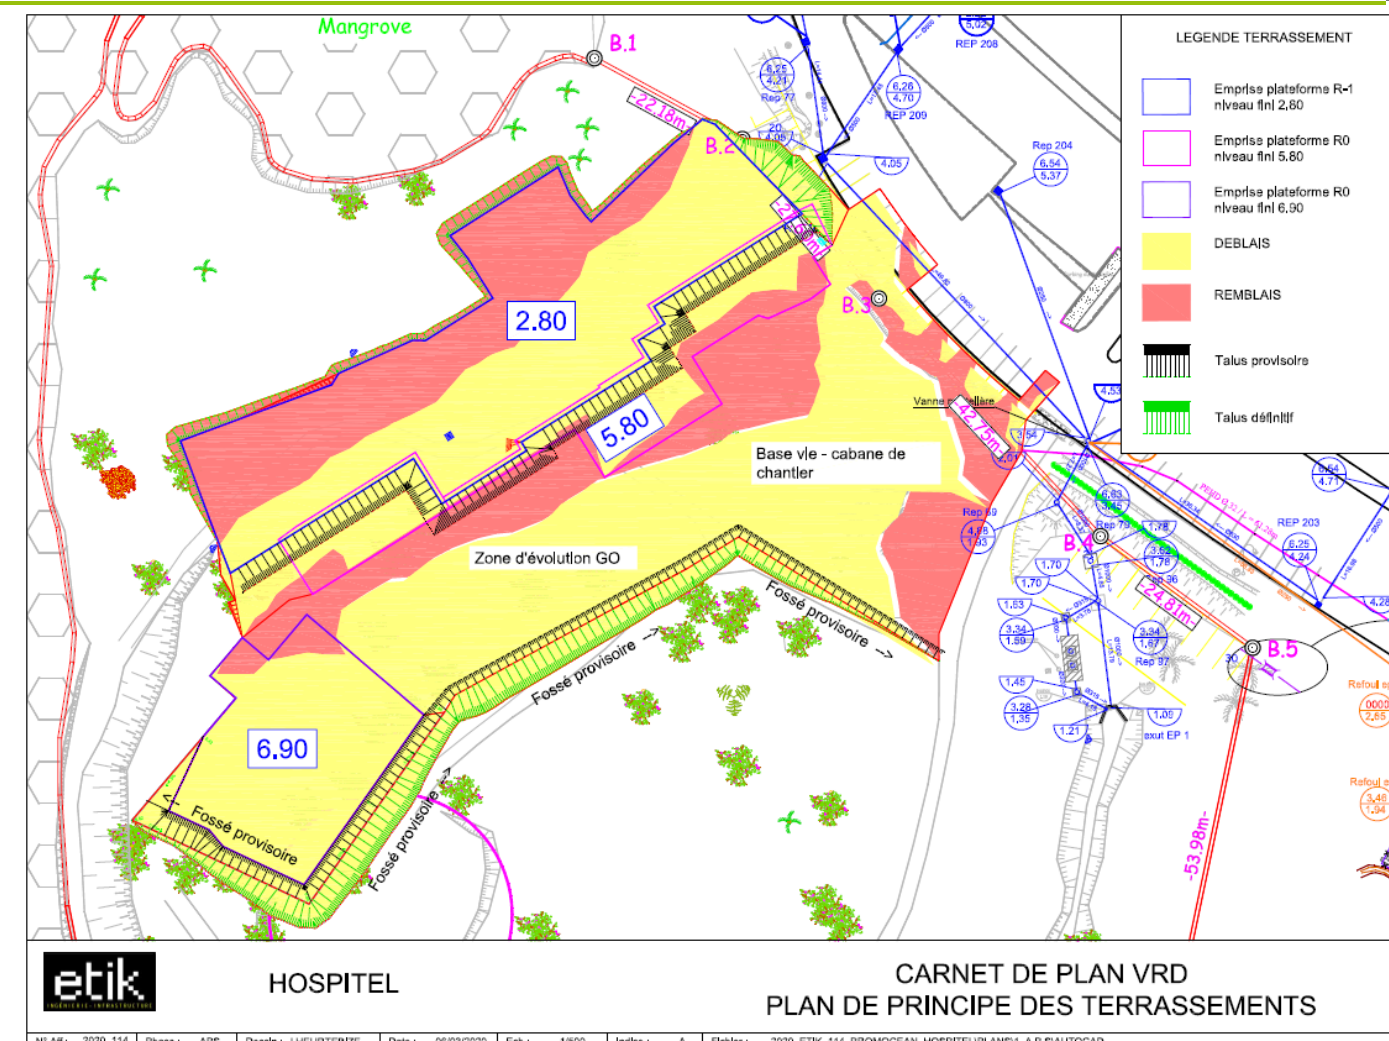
Vue en plan des terrassements (Source : ETIK, APS mars 2020)
